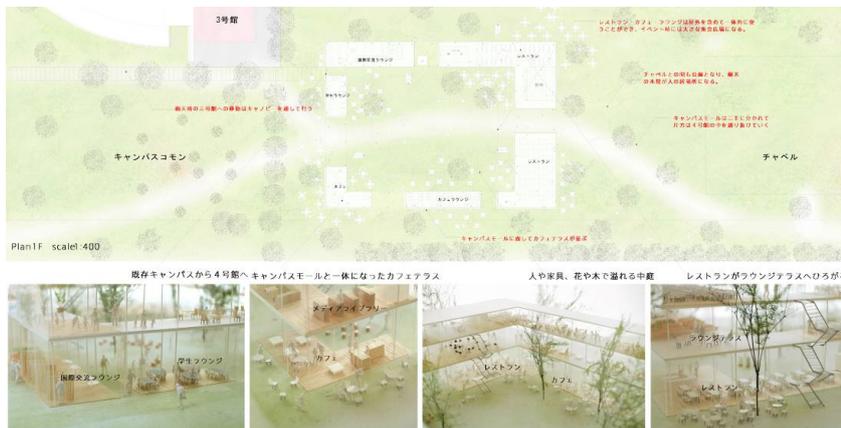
共愛学園前橋国際大学設計競技案 1 階平面図
